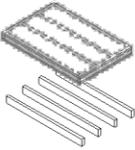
DETAILPUNKT AW-GD =EINBINDUNG DER GESCHOSSDECKE IN DIE AUSSENWAND
